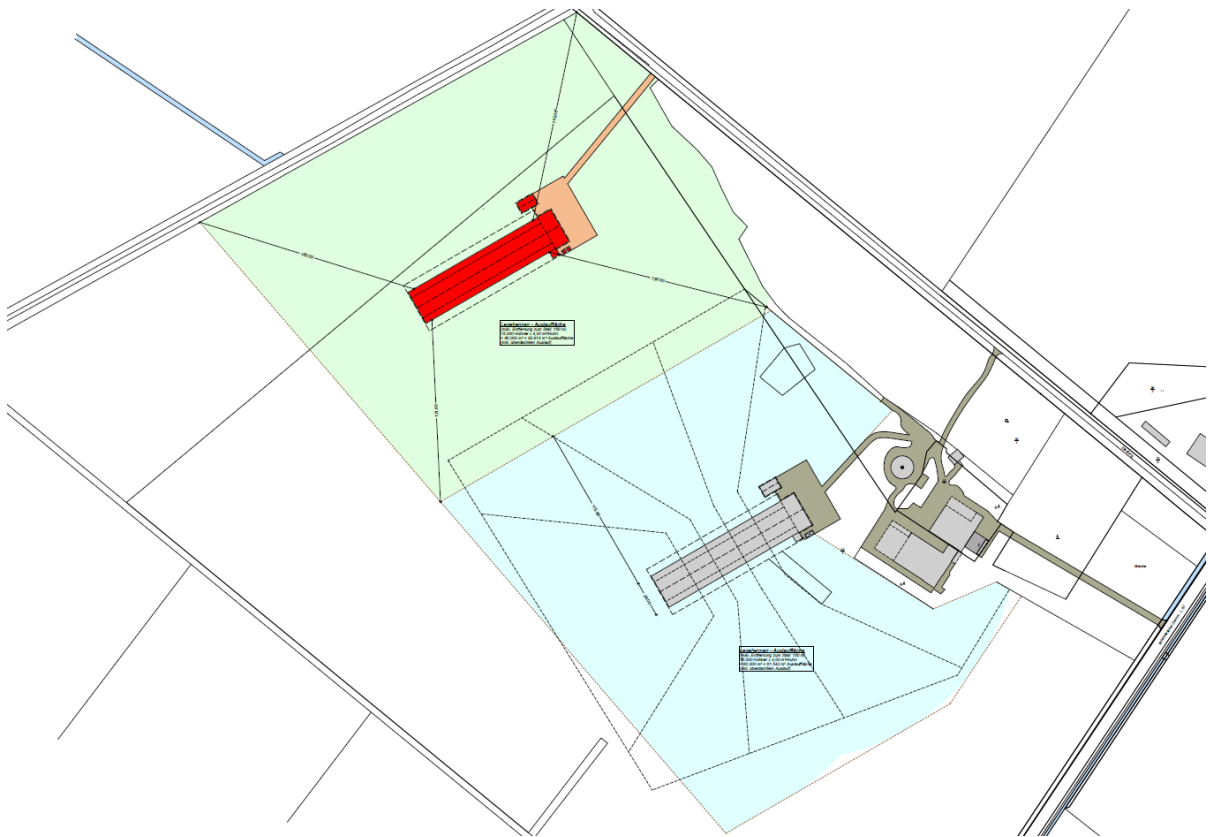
Lageplan zum Bauvorhaben (NBS 2024) (unmaßstäblich)
